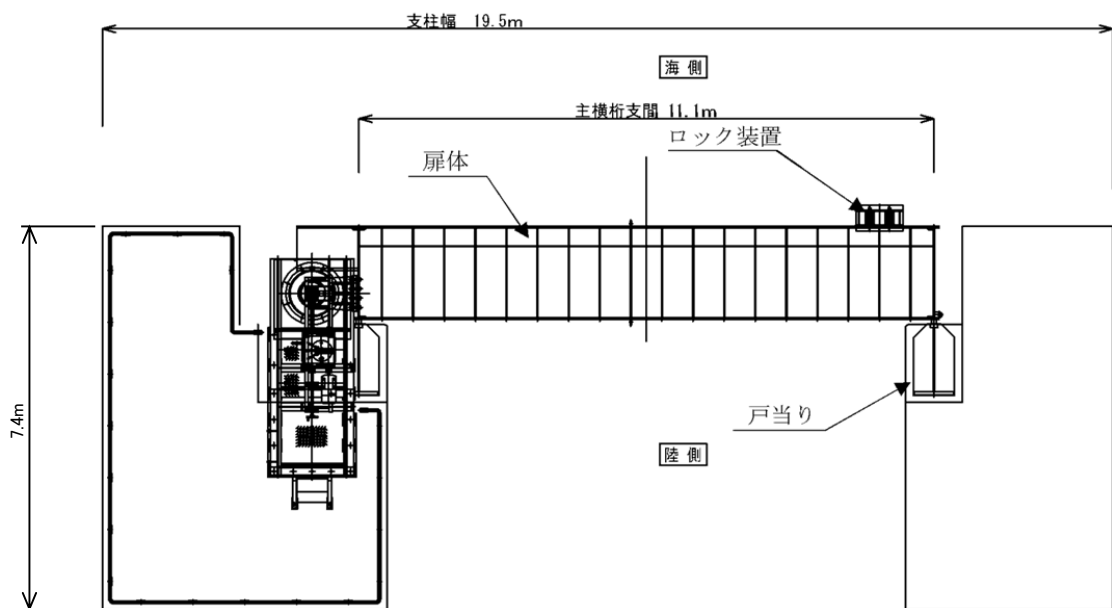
(2) 漂流物対策工の構造図（鋼製扉体，平面図）
